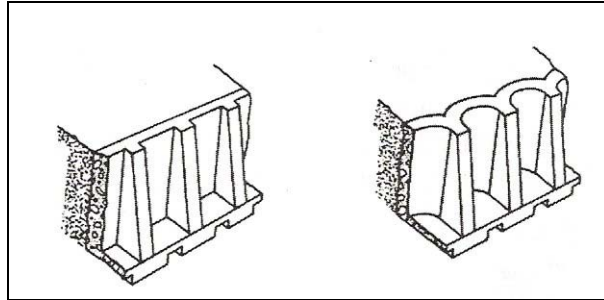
Muro de contrafuerte de pantalla plana y abovedado
